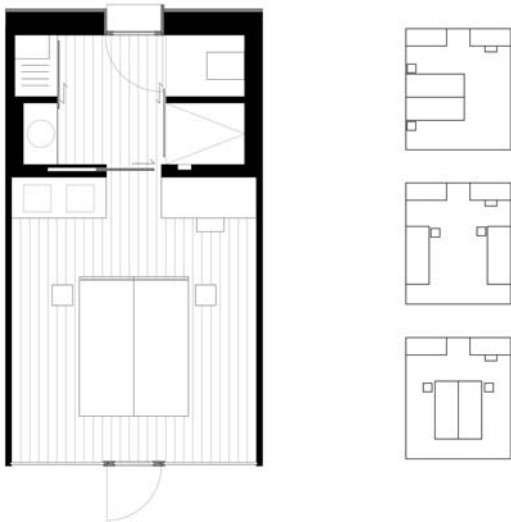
Grundriss Zimmer, Möblierungsmöglichkeiten
